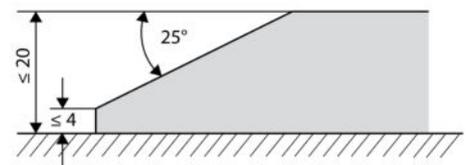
Schräge an einer Tür- oder Torschwelle (Maße in mm) (Quelle: ASR V3a.2)
